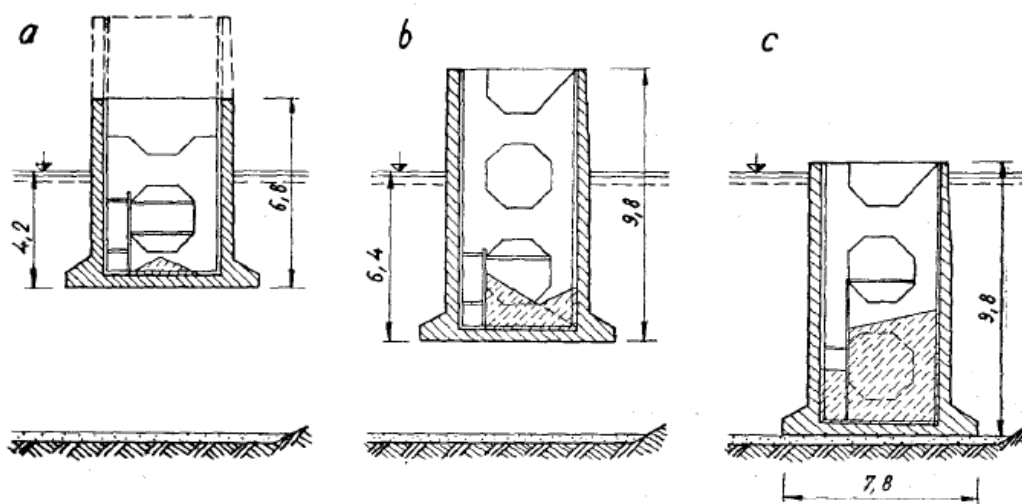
Kesonový základ Zdroj: [1]
